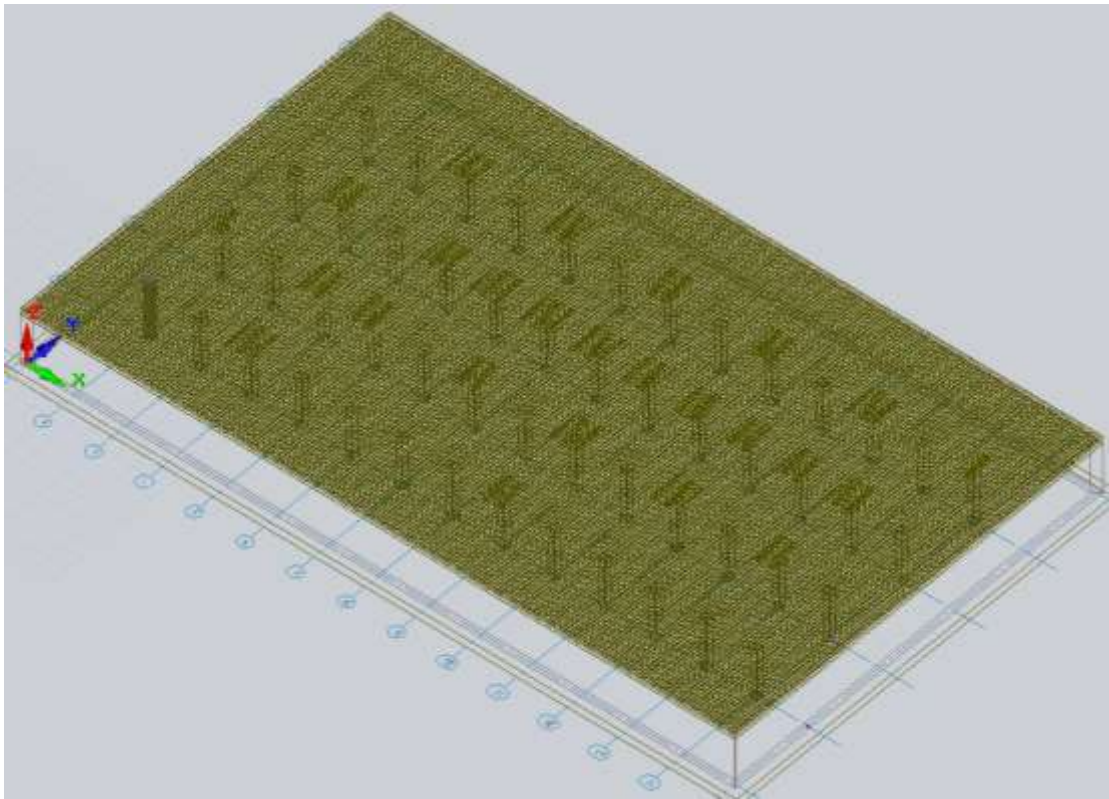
Армування плити перекриття (САПФІР-3D)
